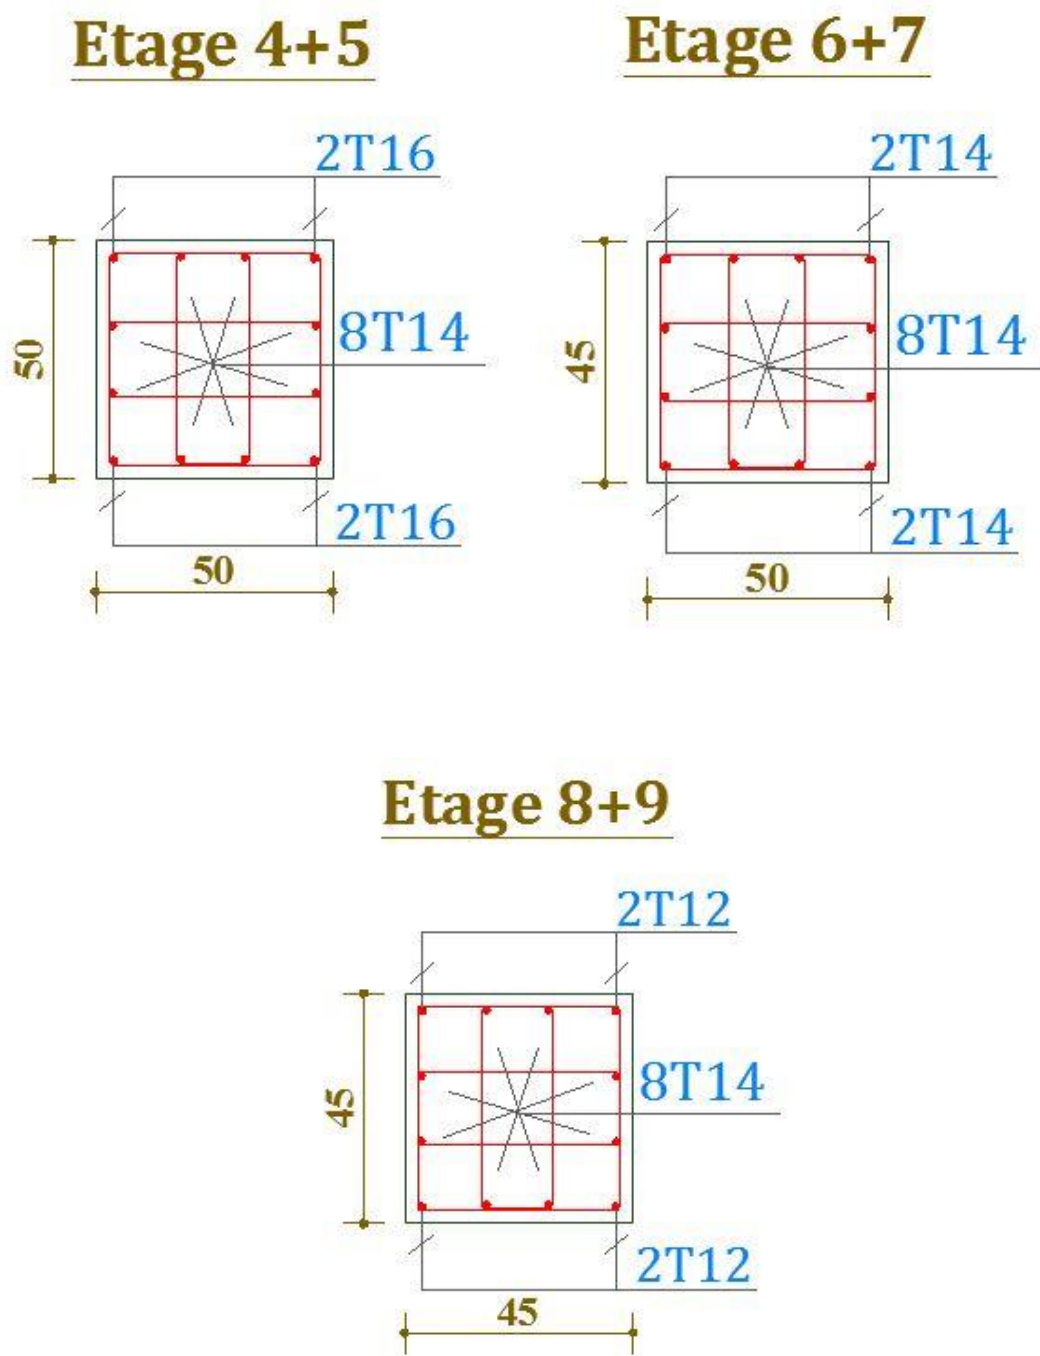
Les schémas de ferrailage des poteaux des différents niveaux.
